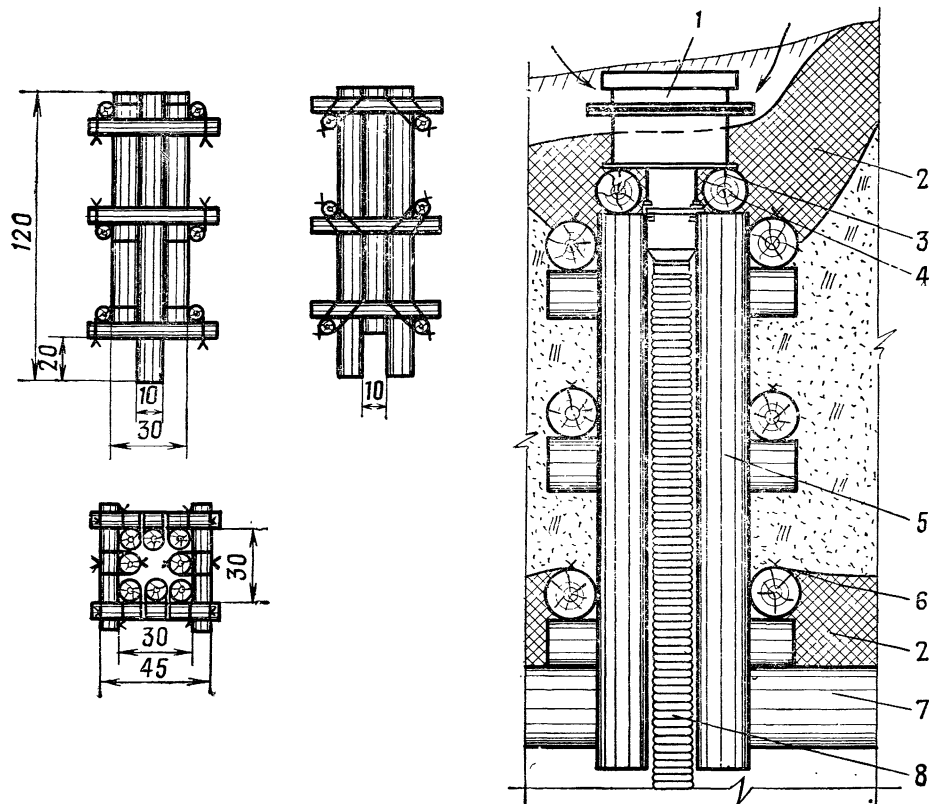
Короб из круглого леса для пропуска воздухозаборного шланга ФВА-50/25:
